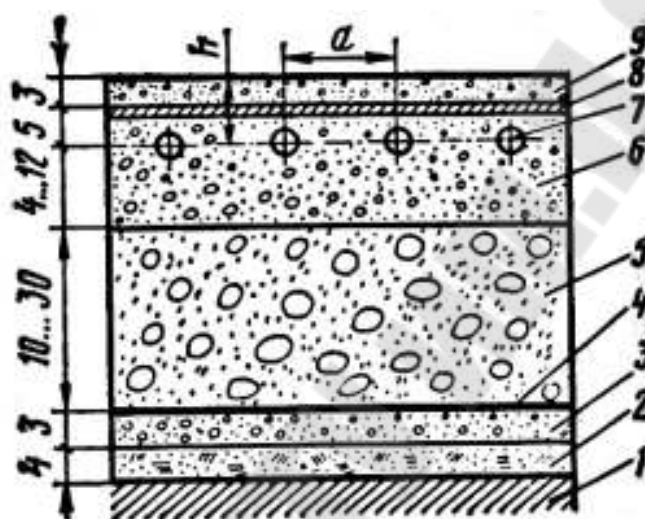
Устройство электрообогреваемого пола (размеры в сантиметрах): 1 – грунт; 2 – щебень; 3, 6 и 9 – бетон; 4 – гидроизоляция; 5 – теплоизоляция (котельный шлак); 7 – нагревательный элемент; 8 – защитная сетка
